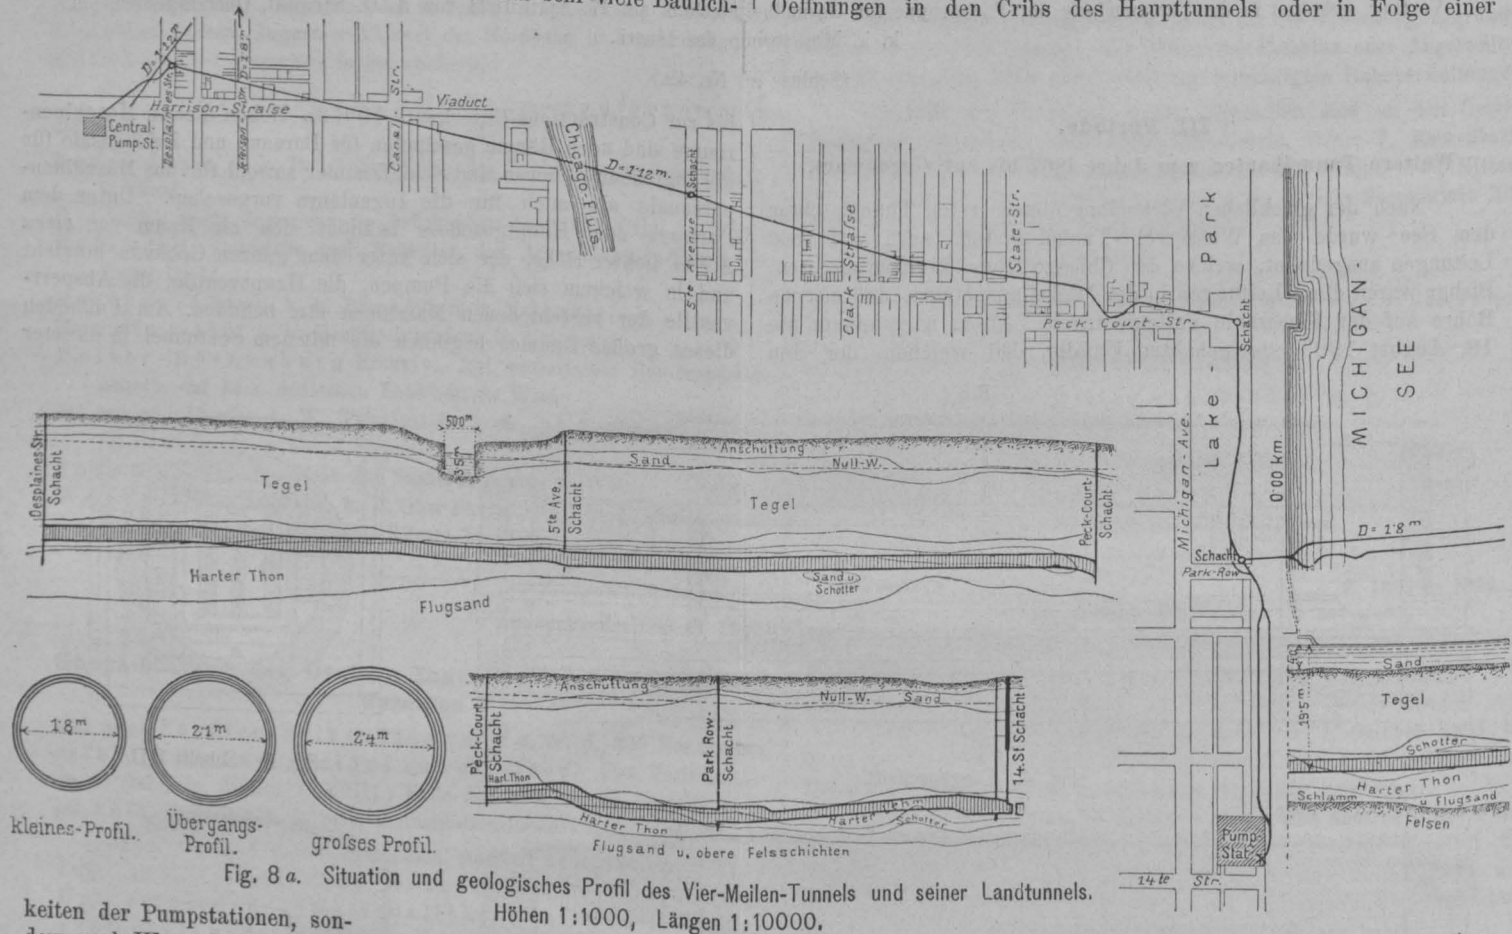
a. Situation und geologisches Profil des Vier-Meilen-Tunnels und seiner Landtunnels. Höhen 1:1000, Längen 1:10000.
